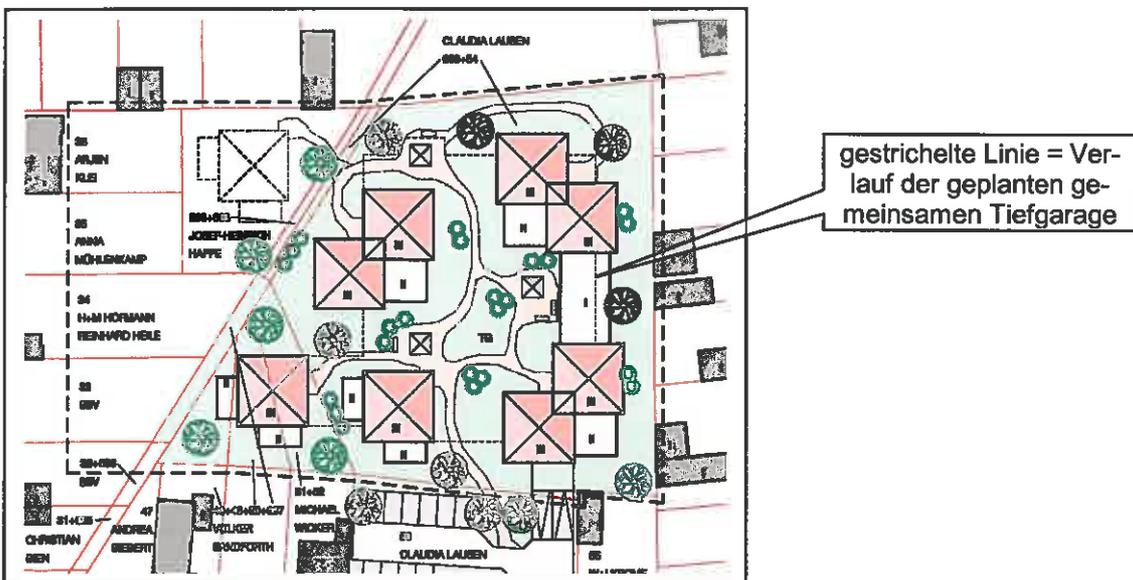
Ausschnitt aus Lageplan Antrag Aufstellung B-Plan
